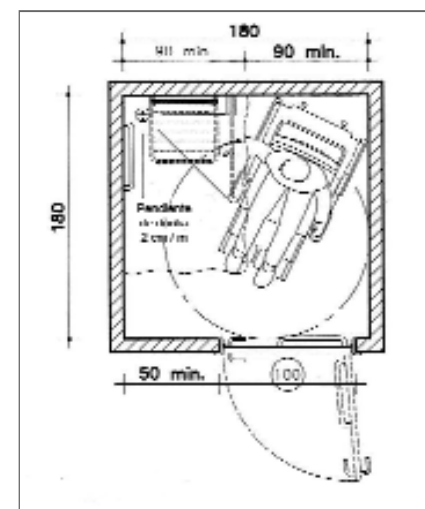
Dimensiones de una ducha adaptada para usuarios de silla de ruedas.
